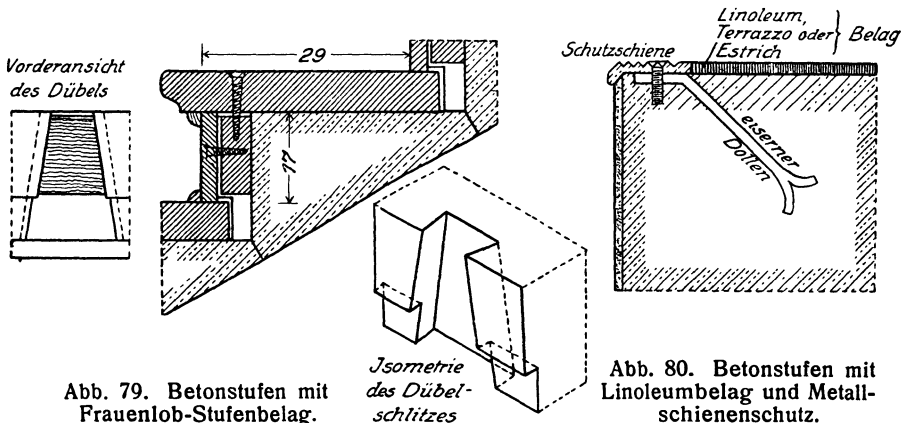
Betonstufen mit Frauenlob-Stufenbelag.
